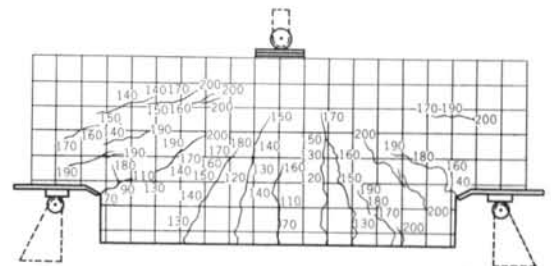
試験体A<sub>2</sub>裏面のひび割れ図
